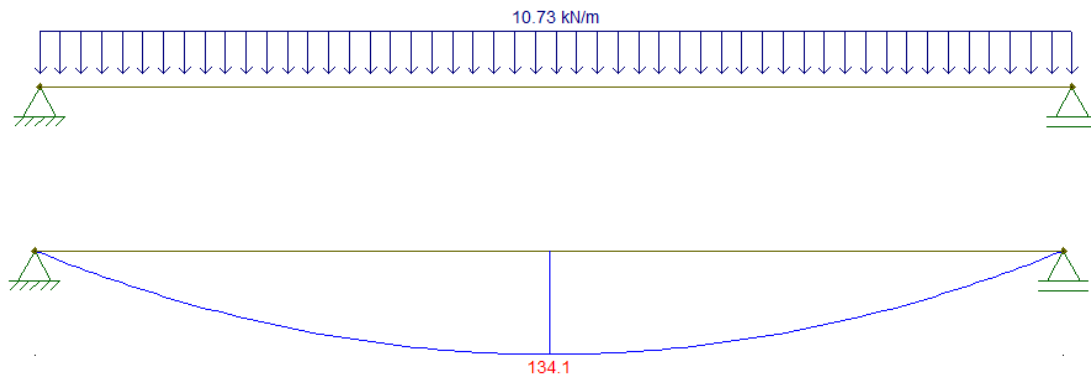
Modelo de cálculo para vigas bajo cubierta inaccesible centrales. Fuente: Elaboración propia
